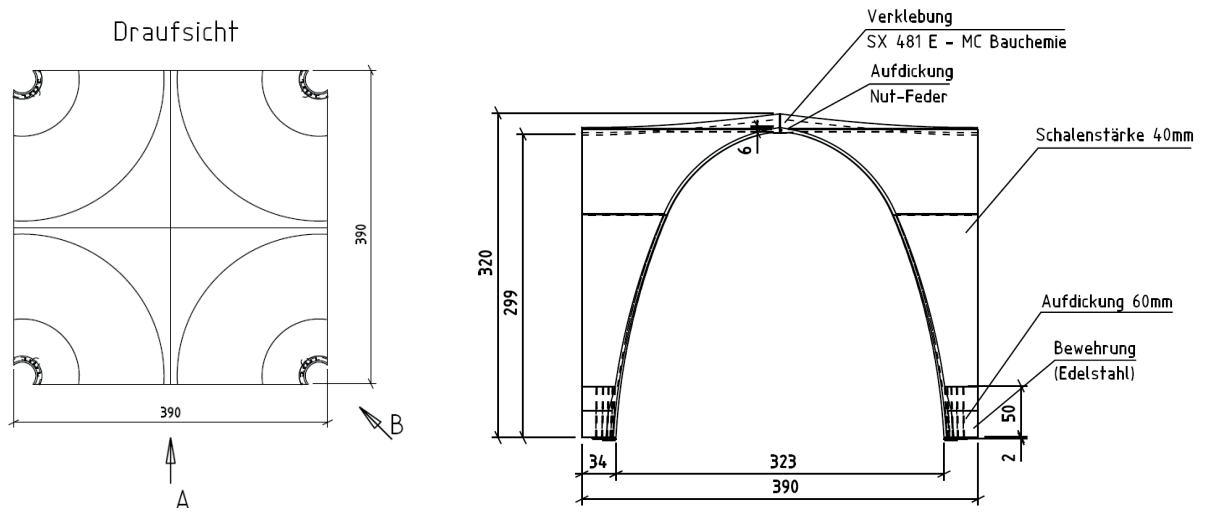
Zeichnung der Textilbeton-Pavillons „TexLeS“ (Draufsicht, Schnitt)
